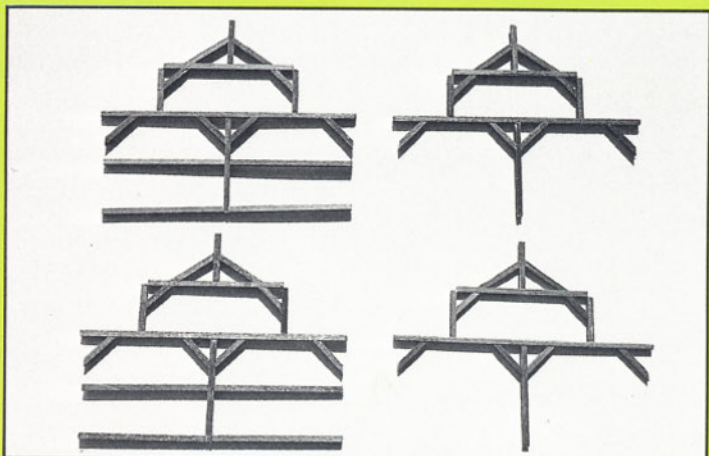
Stützbalken-Konstruktion der Scheune, montiert nach dem eben beschriebenen Verfahren.
